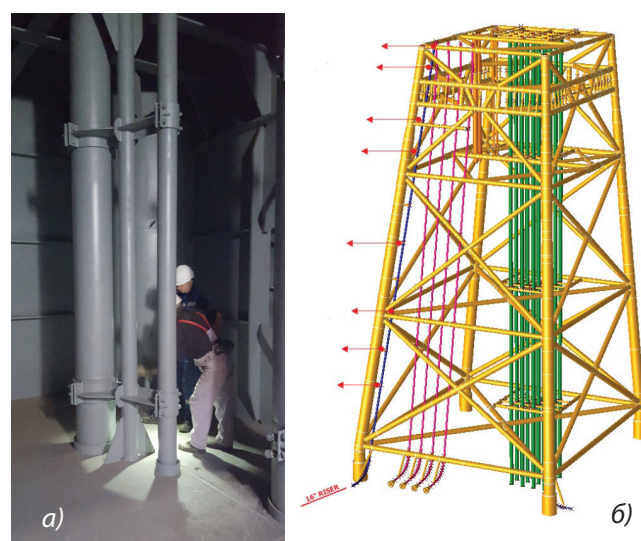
Примеры конструктивного оформления стояка (а) и райзера (б) (для райзера стрелками показаны узлы его крепления стойке опорного блока)
